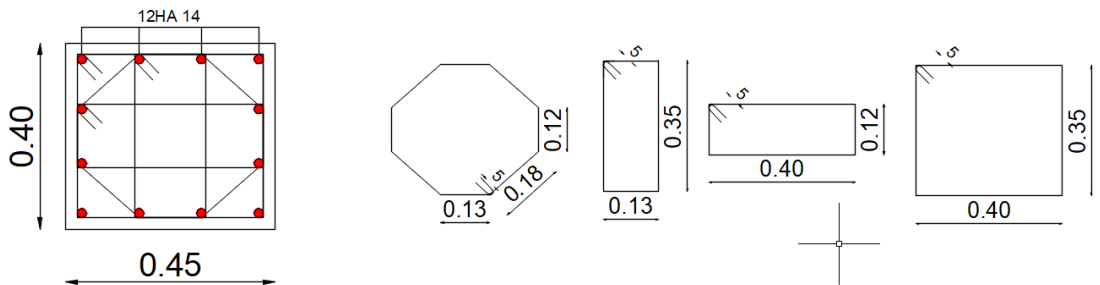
Schéma de ferrailage du poteau (55 x 60 cm<sup>2</sup>)
